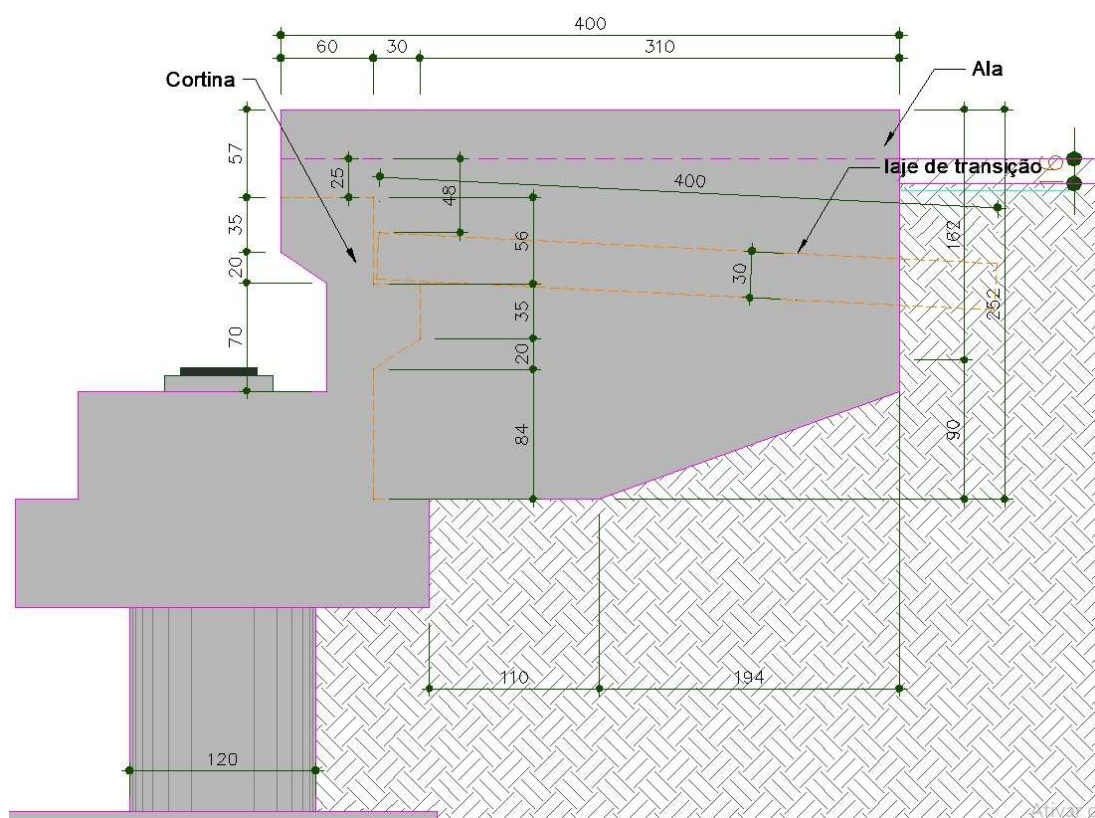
concepção da cortina, laje de transição e ala e seu pré-dimensionamento.
